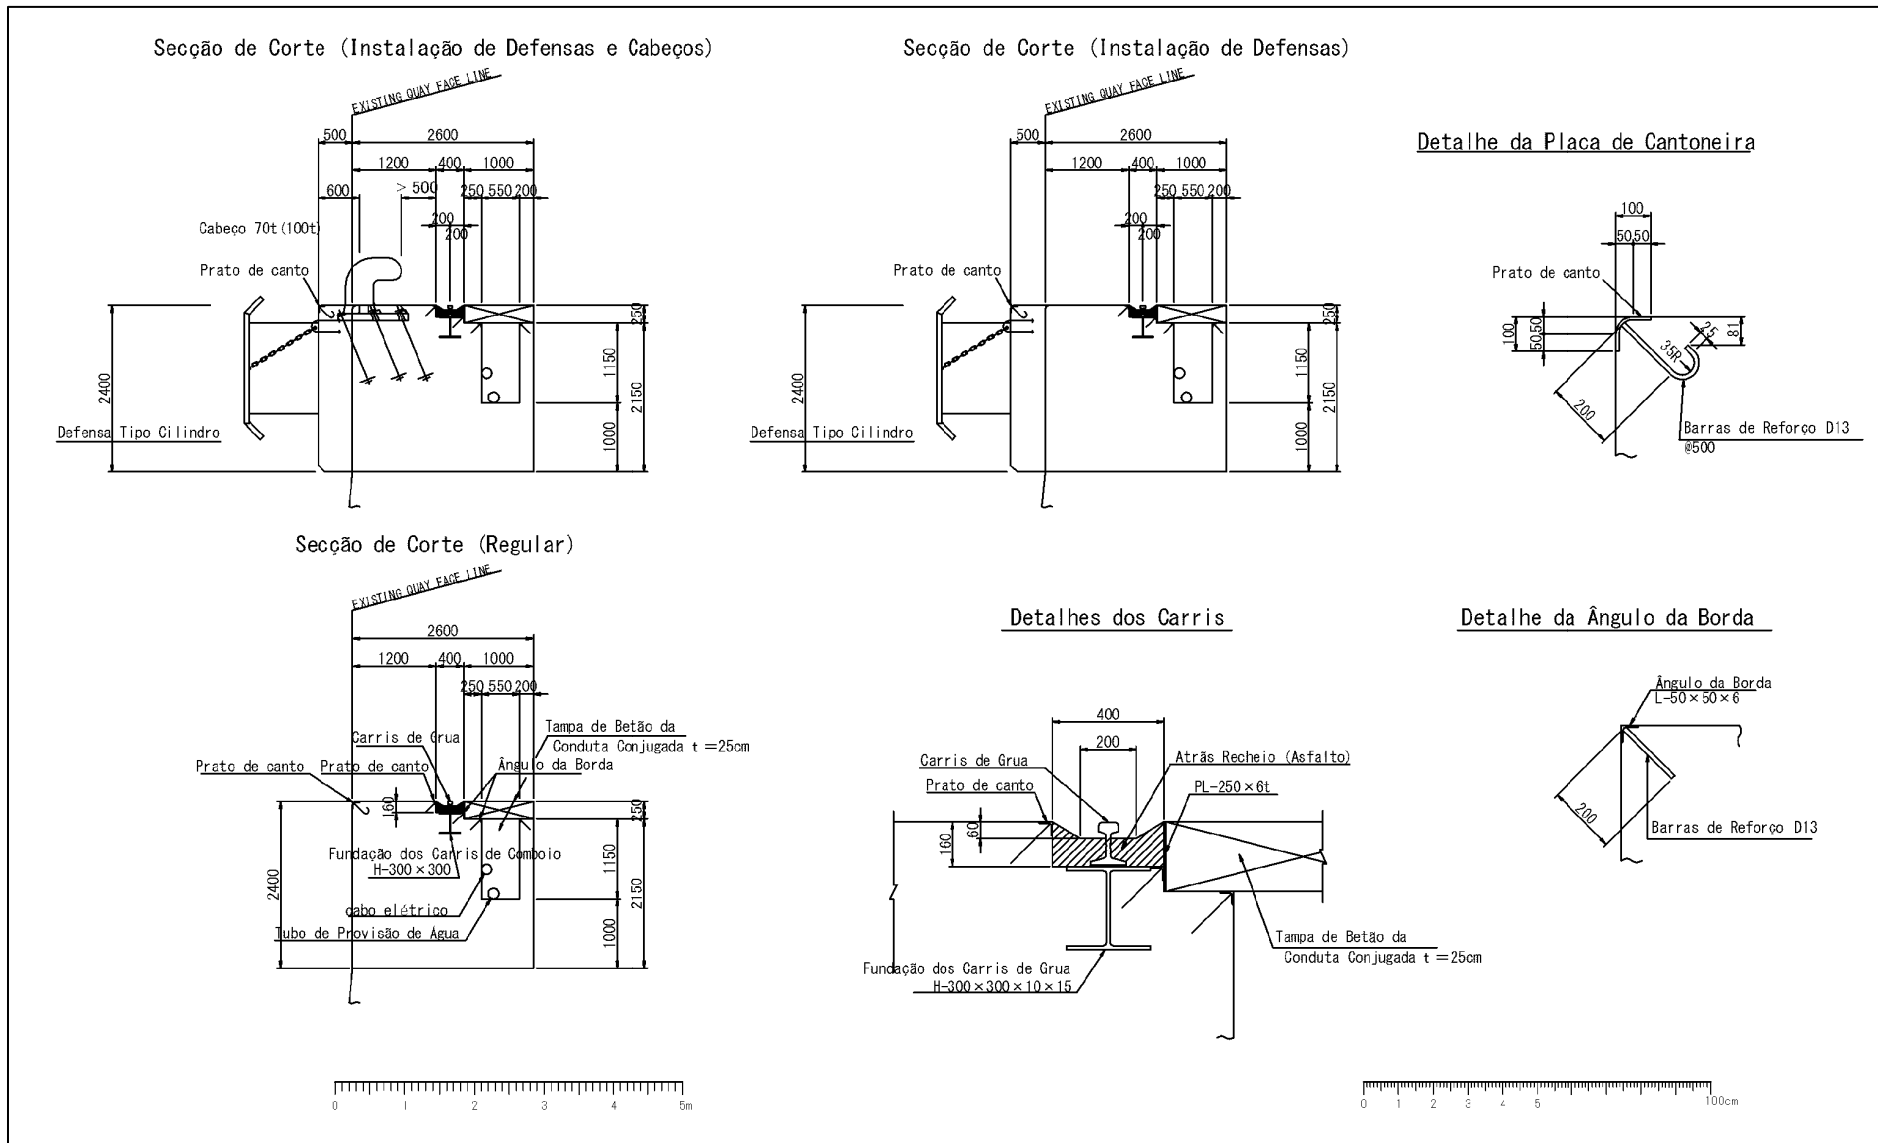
Planta Detalhada do Coroamento do Muro
